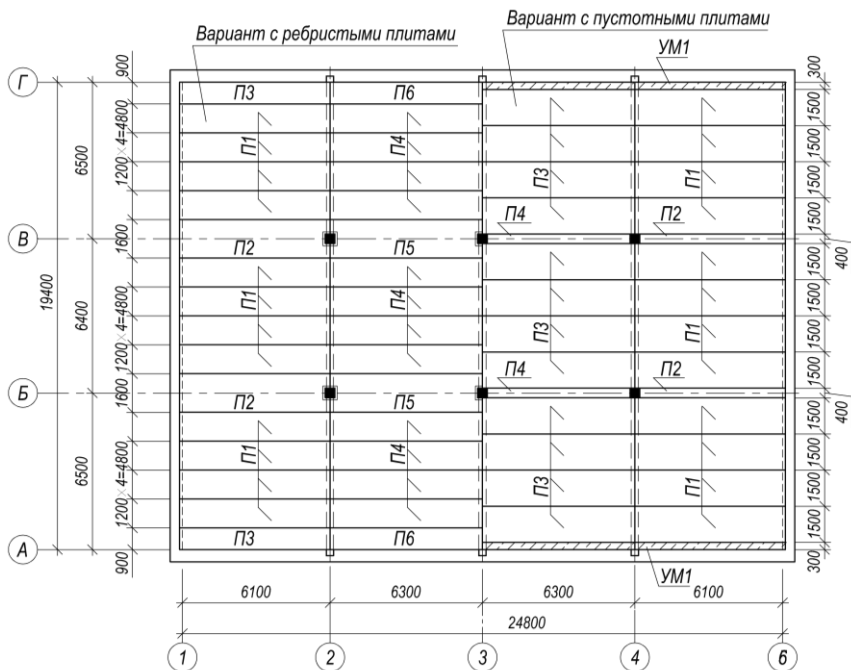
Раскладка в плане перекрытия сборных плит (1-й вариант)
